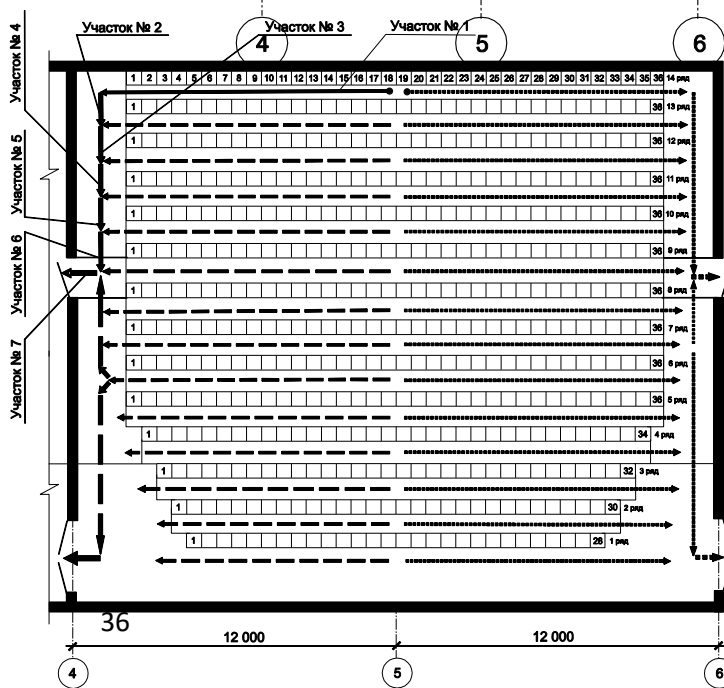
Фрагмент схемы этажа здания с расчетной схемой эвакуации:
